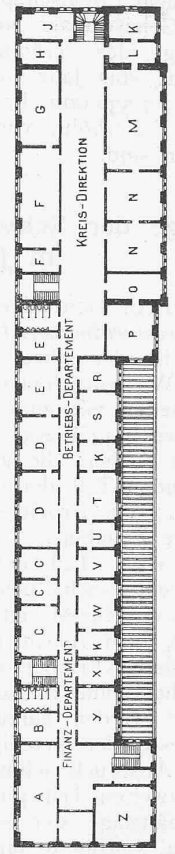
Grundriss vom I. Stock des Verwaltungsgebäudes. — Masstab 1:1000.
